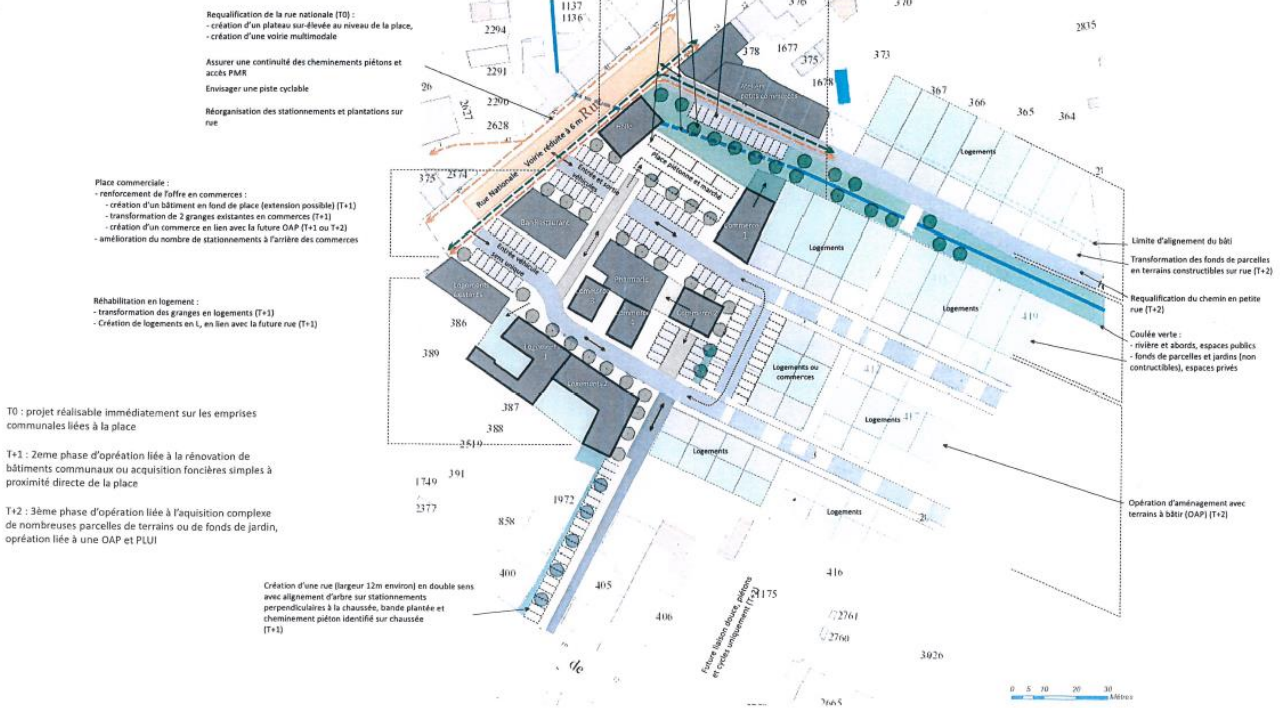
Etudes d'aménagement de la Place Jean-Baptiste MOREAU (ADAC – Mars 2016)
